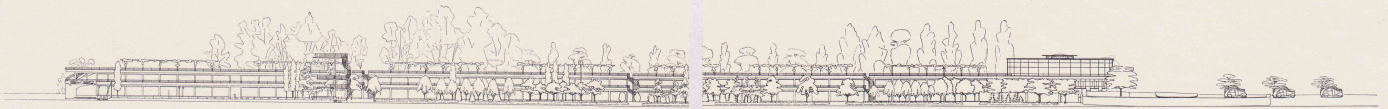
Façade vers le lac. Echelle 1 : 800.
